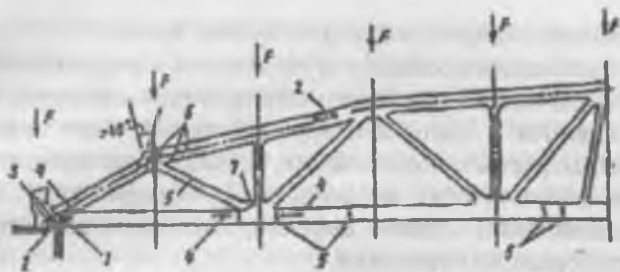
Характерные повреждения силового происхождения в железобетонных фермах с нижним предварительно напряженным поясом.
